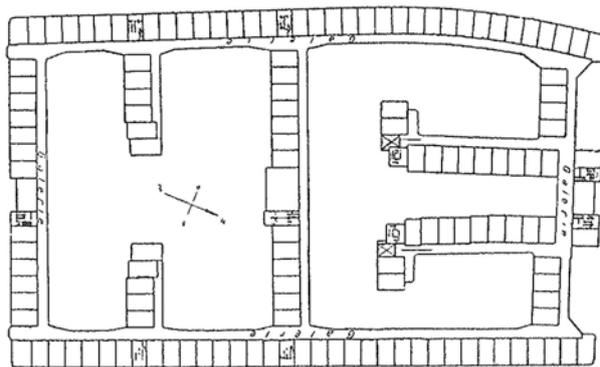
Gesamtgrundriss 2. Obergeschoss mit Roof Street in Spangen
